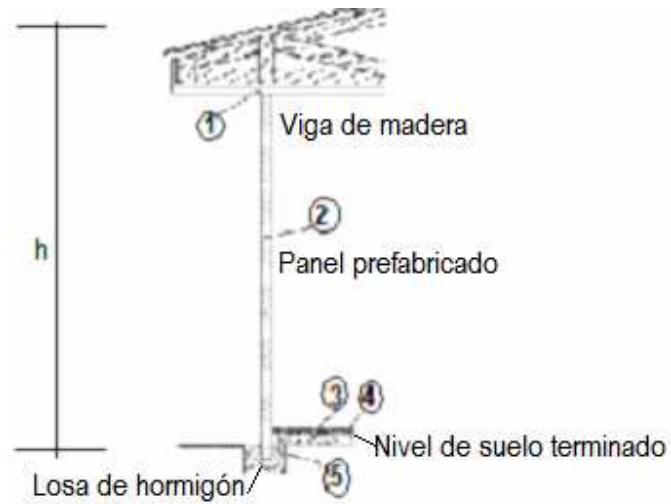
Construcción mixta. 1- Viga de madera de coronación, 2-Panel prefabricado de hormigón, 3-Losa de hormigón "in situ", 4-Nivel de suelo terminado, 5-Cimentación in situ.
